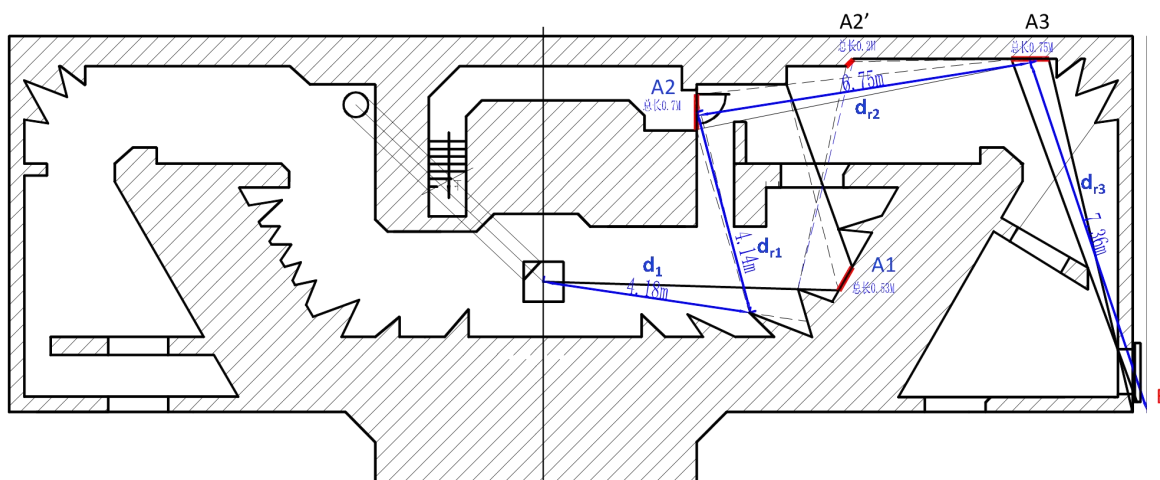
(2) 辐照室散射路径示意图 (平面图)
